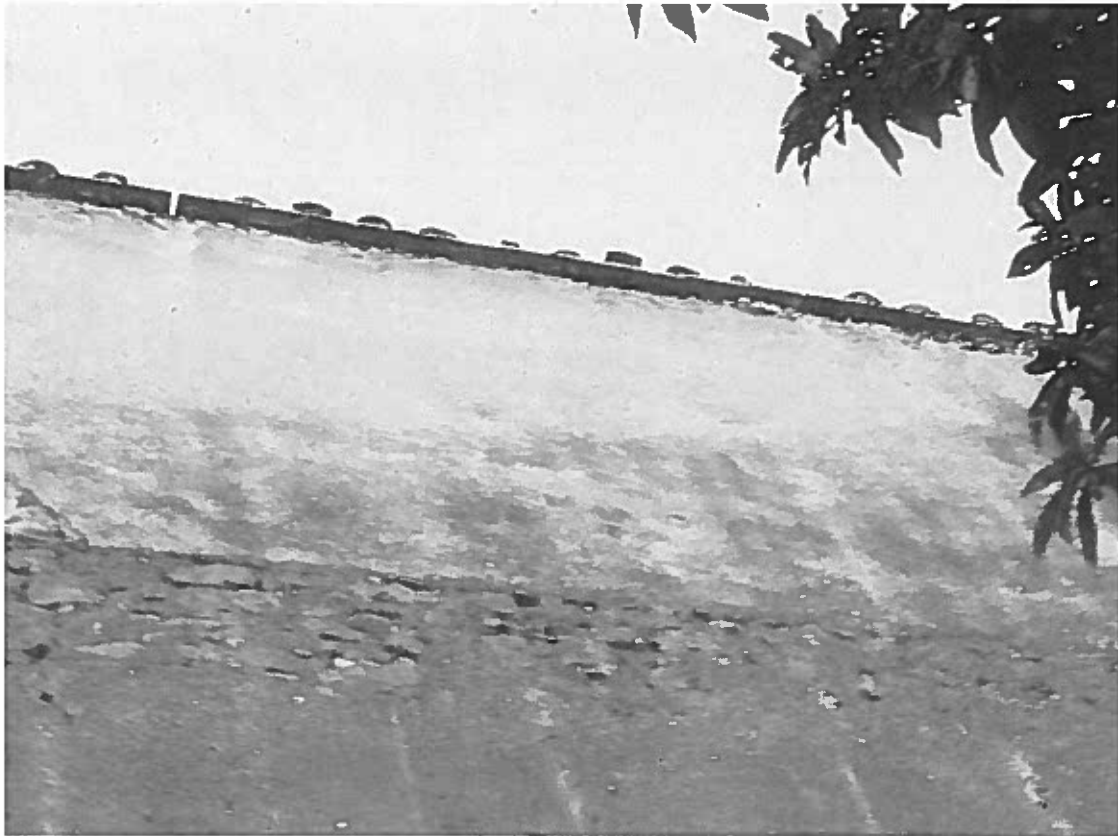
Dettaglio distacco tegole ed embrici di protezione sommità muro
